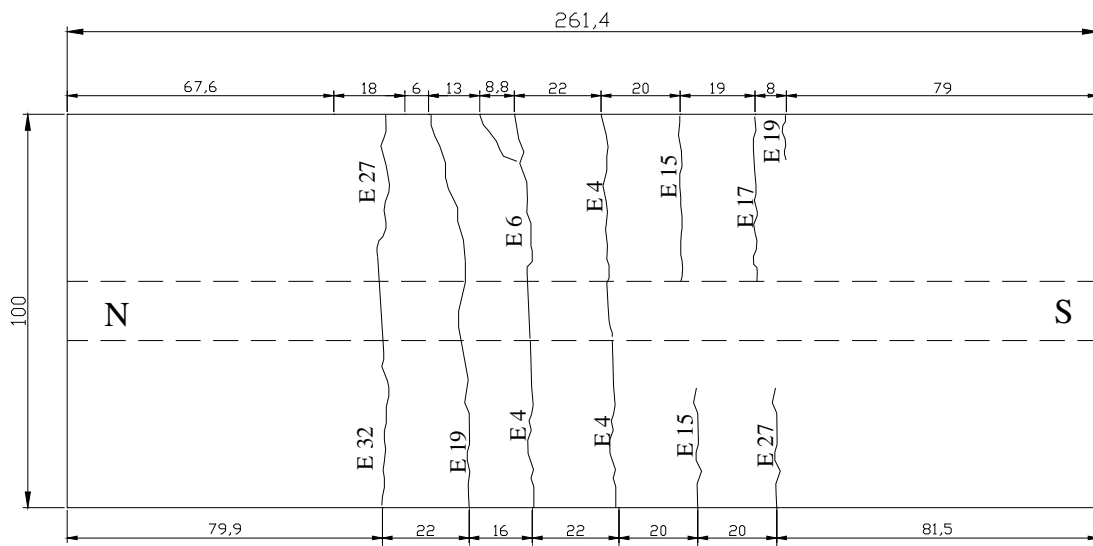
Fissuras do modelo 1A (face superior da laje) – medidas em cm.
